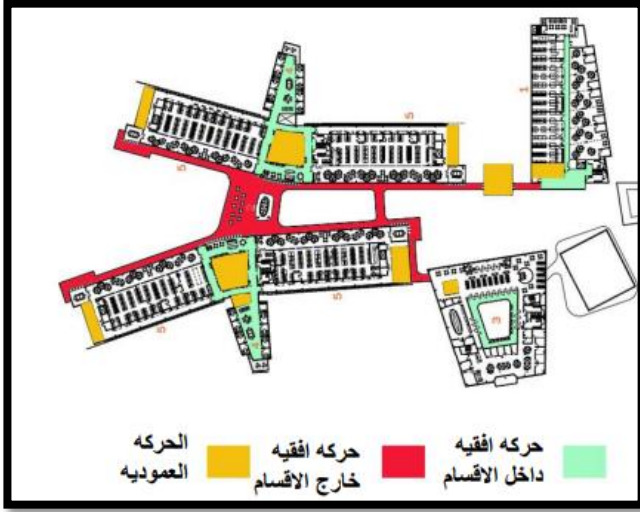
مسقط الطابق الاول مكرر لمركز فوندازيوني في ايطاليا .
